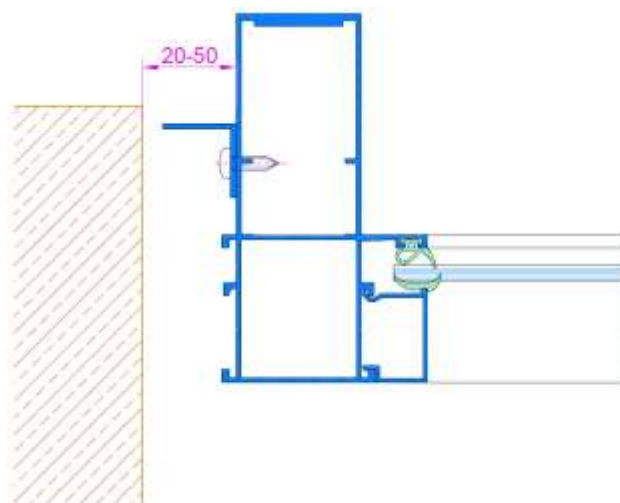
Размеры монтажных зазоров (швов) при установке алюминиевых конструкций
